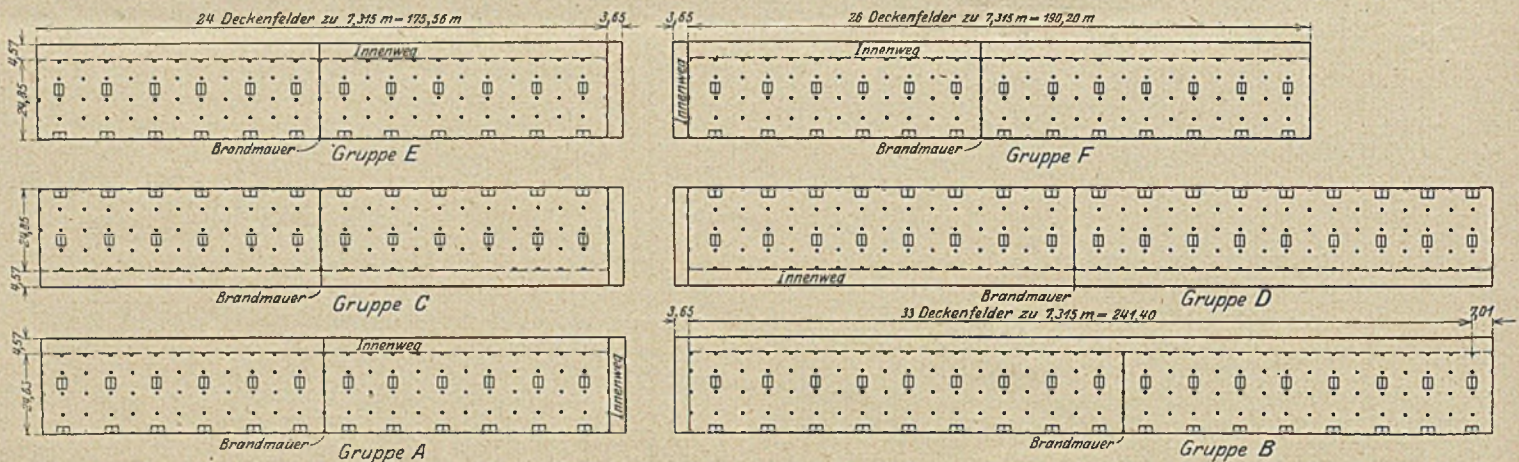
a. Bau der Markthallen in Chicago: Anlage im Grundriß.
